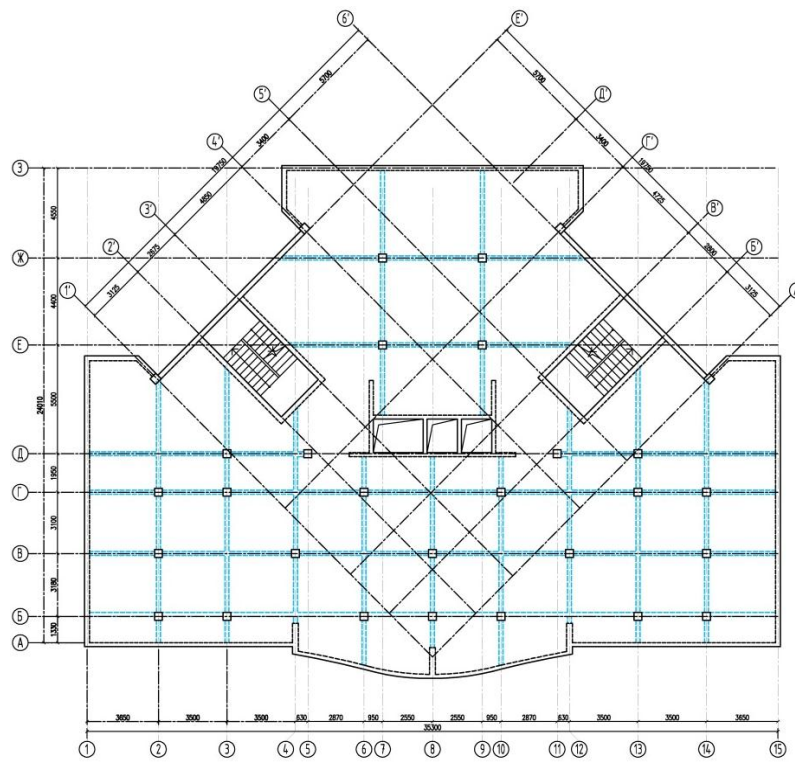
Конструктивна схема перекриття типового поверху будівлі
